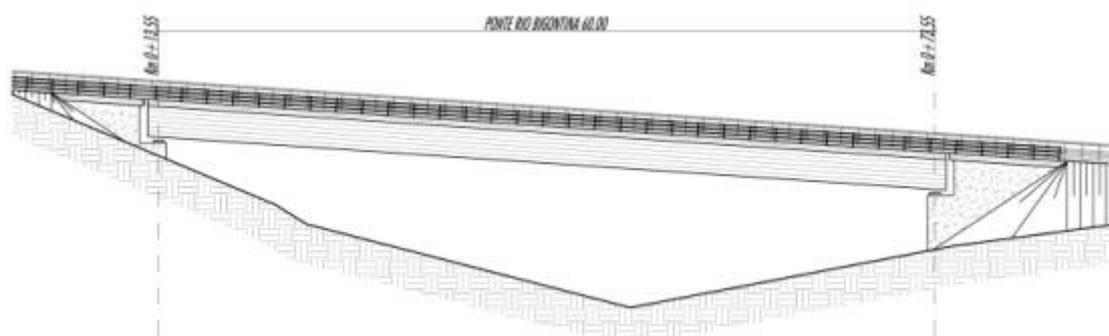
Prospetto del Ponte sul Rio Bigontina (ns. elaborazione da tavola T01VI02STRDI01_A_Sezione longitudinale, prospetto e schema appoggi del progetto definitivo).
